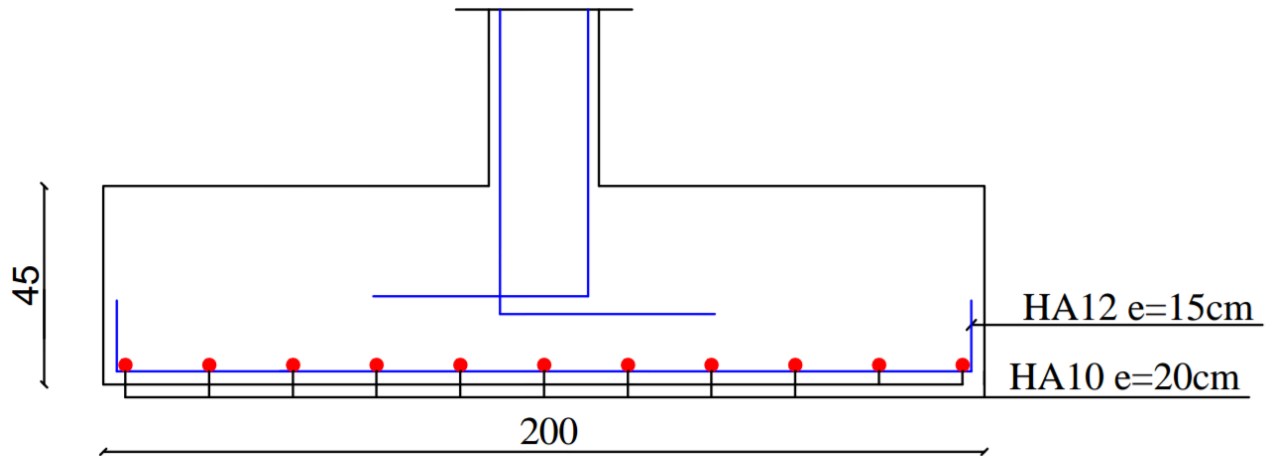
Ferrailage de semelle filant sous voile 2
